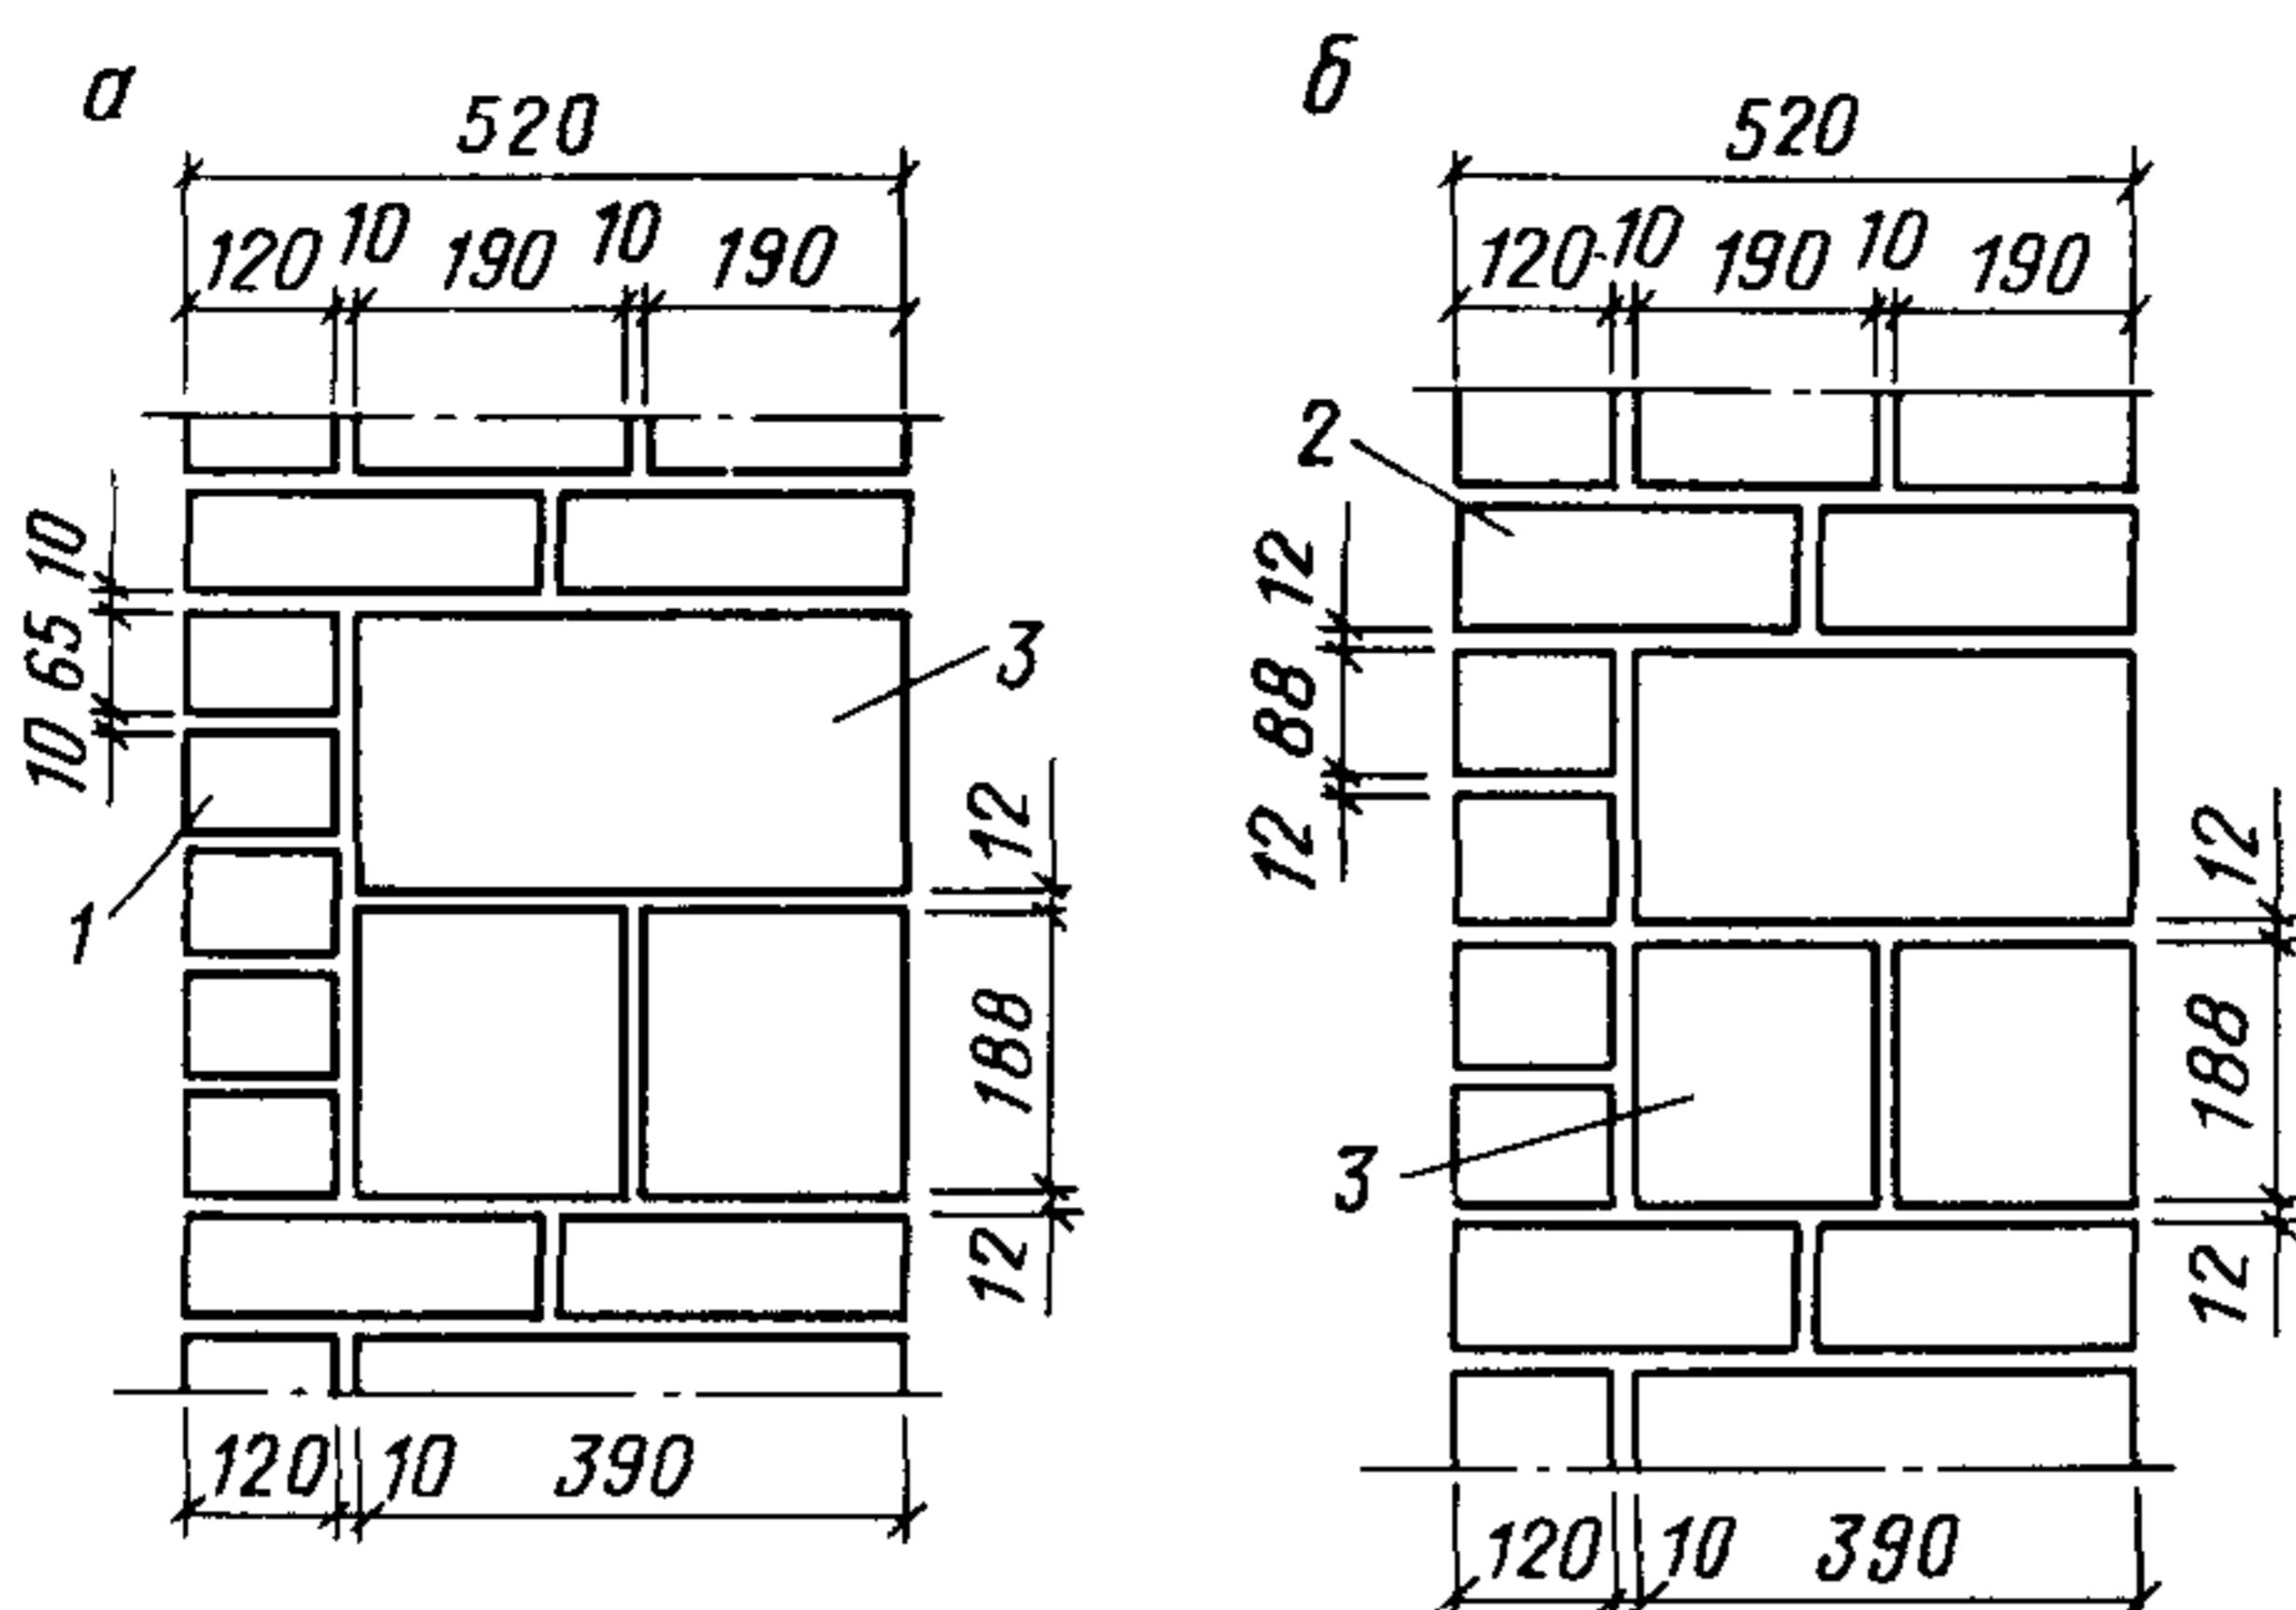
Облицовка лицевым кирпичом стен из бетонных камней
